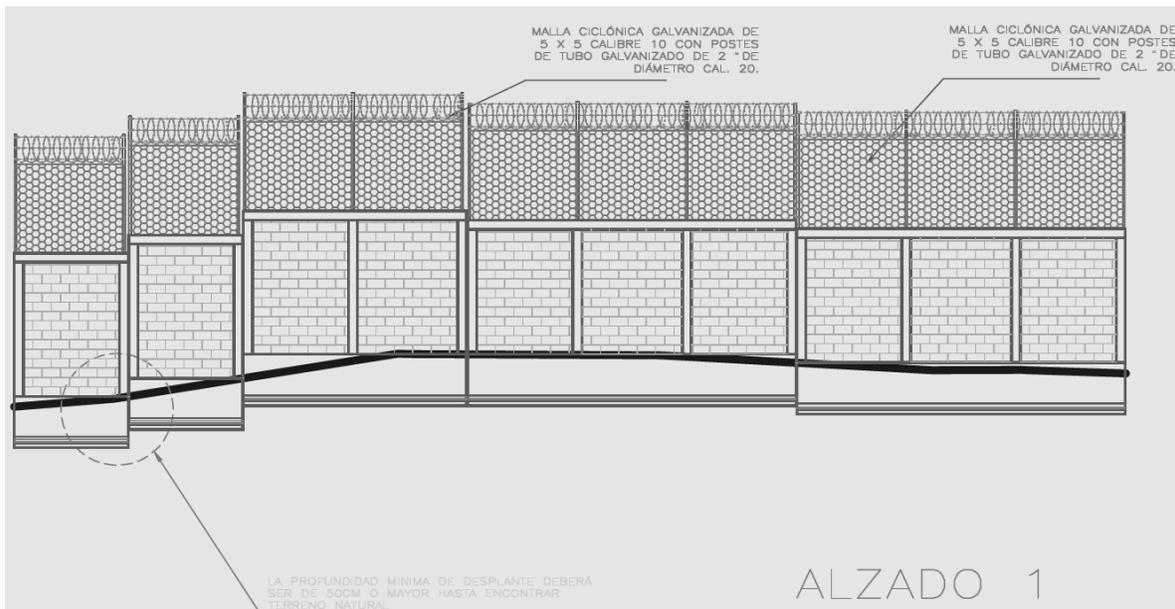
Alzado Tramo 1 de barda perimetral proyectado.
